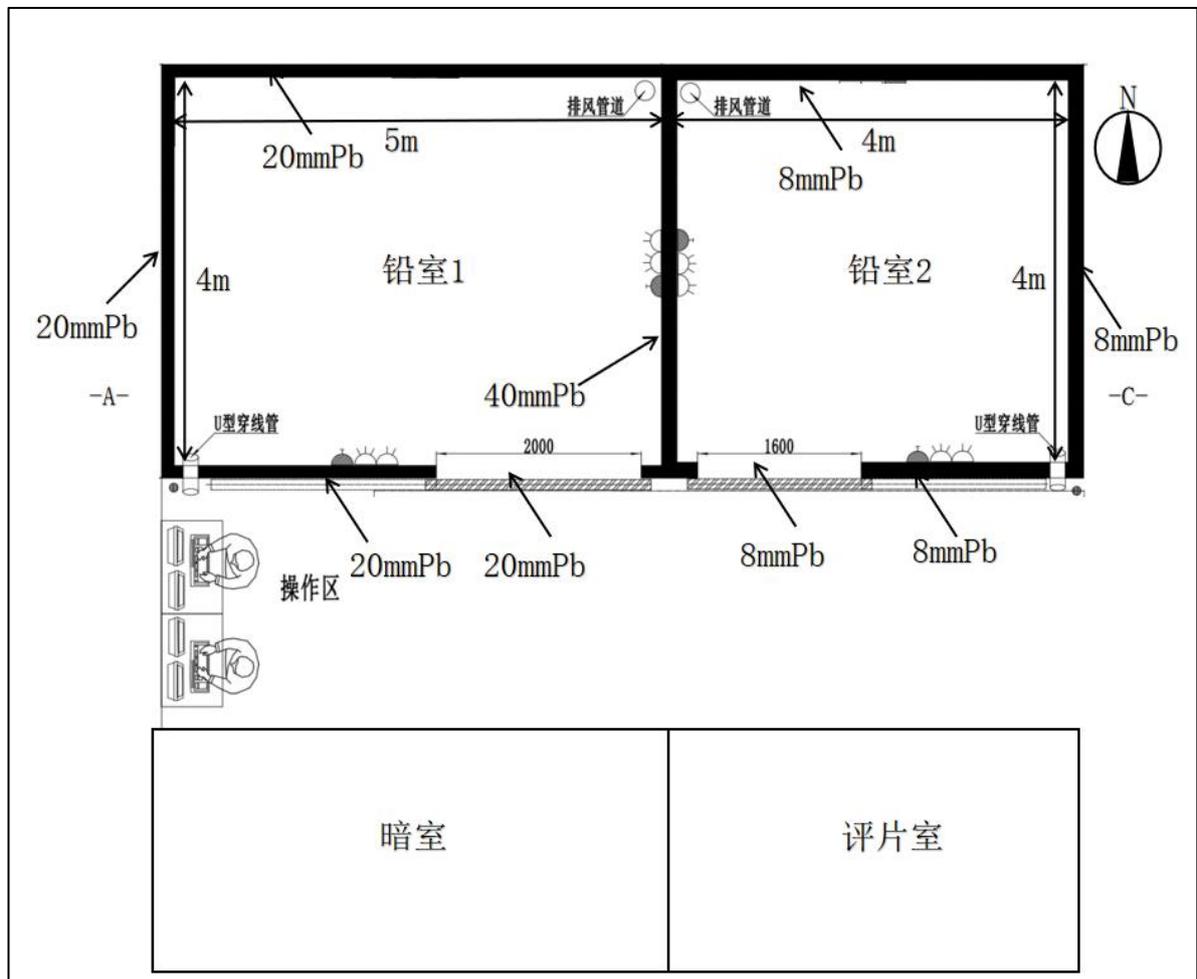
西安朋邦工贸有限公司探伤室平面布置图
